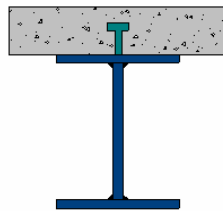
Seção transversal de uma viga-mista aço-concreto
